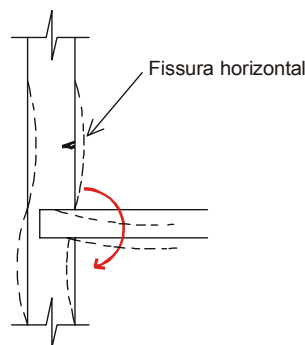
mecanismo de formação de fissuras horizontais na base de paredes por deformação de lajes apoiadas ou ancoradas em alvenarias (THOMAZ, 1989)
